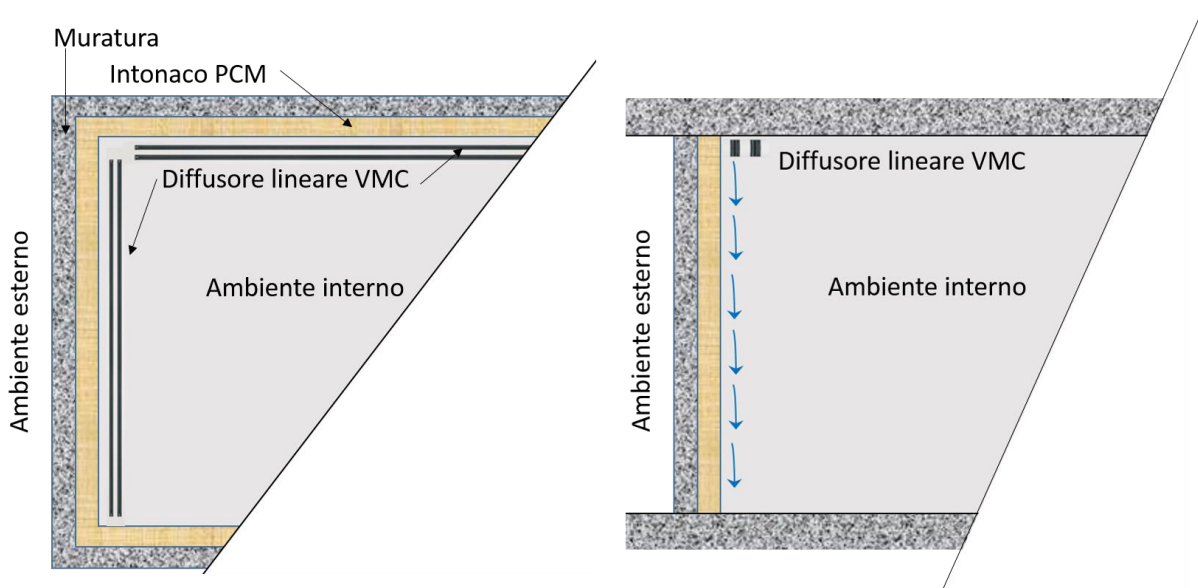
Ventilazione meccanica controllata notturna per scaricare l'intonaco a cambiamento di fase. A sinistra, planimetria; a destra, sezione verticale.
